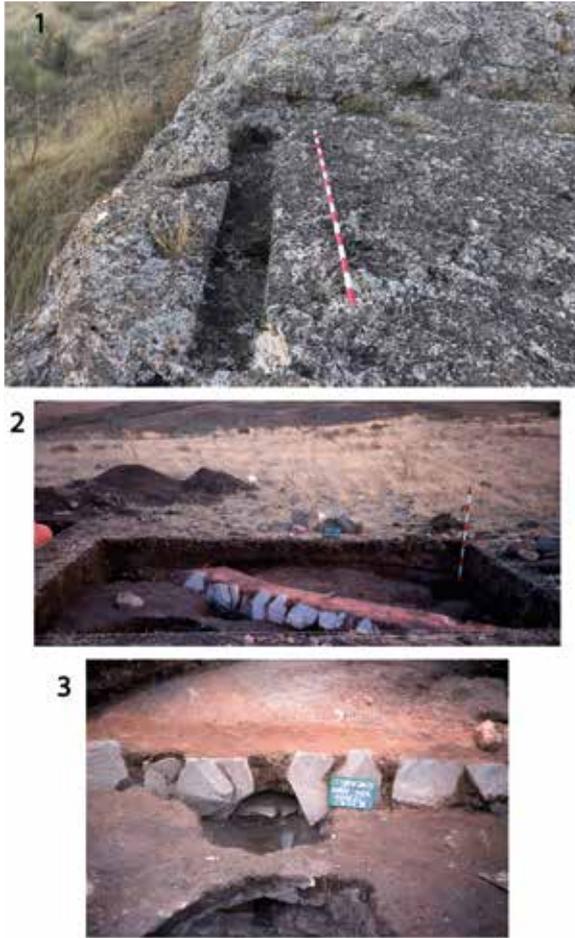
Sistemas de cimentación detectados en Cerro Tormejón: 1. Zanja de cimentación tallada en la roca y pequeño canal de desagüe (parte superior de la zanja); 2. Muro de adobe inserto en un cajeadado de lajas de pizarra; 3. Detalle del encofrado de lajas (fotografías 2 y 3 cortesía de Francisco Gozalo Viejo, director de la campaña de excavaciones en Cerro Tormejón en 1977).
